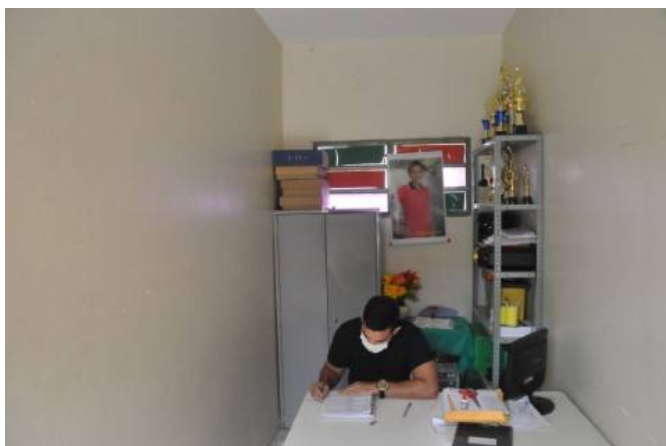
Vista geral: Parede posterior almoxarifado.
